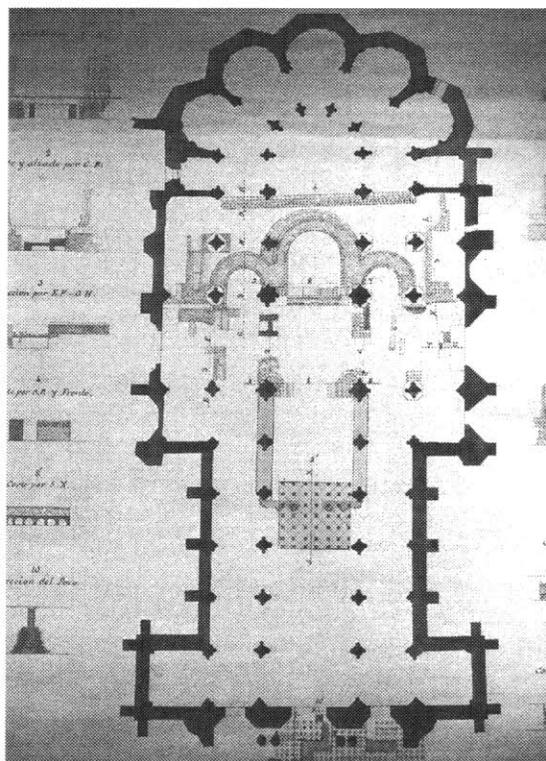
Planta de la catedral de León con la ubicación de las estructuras tardorrománicas excavadas por Demetrio de los Ríos.
